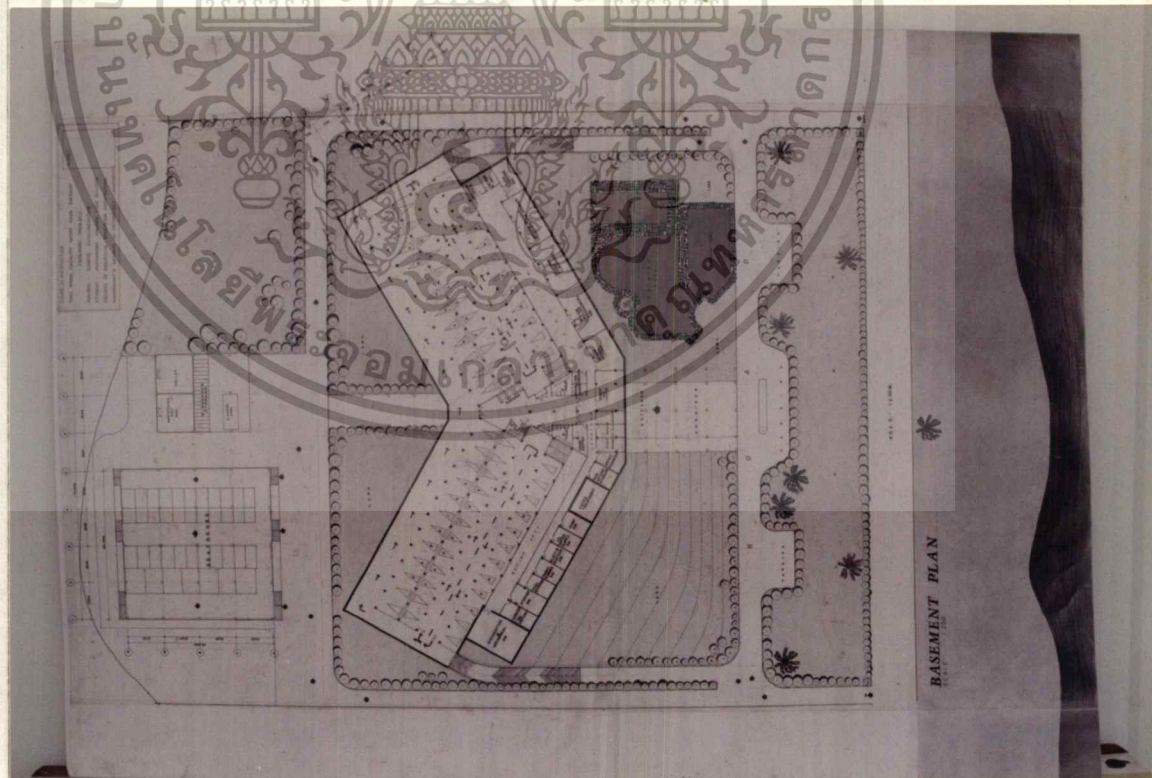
แสดงการวิเคราะห์ระบบเทคนิคของอาคาร (BUILDING SYSTEM)
